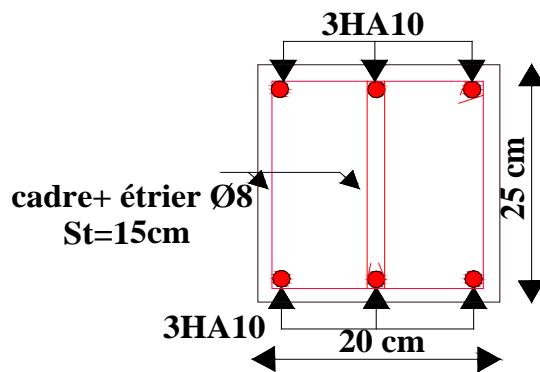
Schéma de ferrailage de la poutre de chaînage
